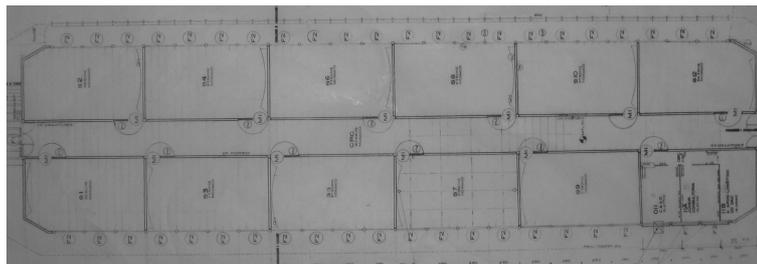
Planta original do Bloco G-67 (Laboratórios DFI) [1980].
